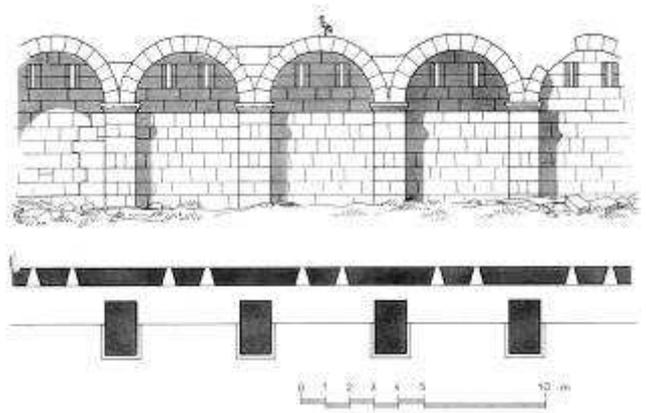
Perge. Pianta e prospetto delle casematte della cinta fortificata di età ellenistica (ADAM 1981)
